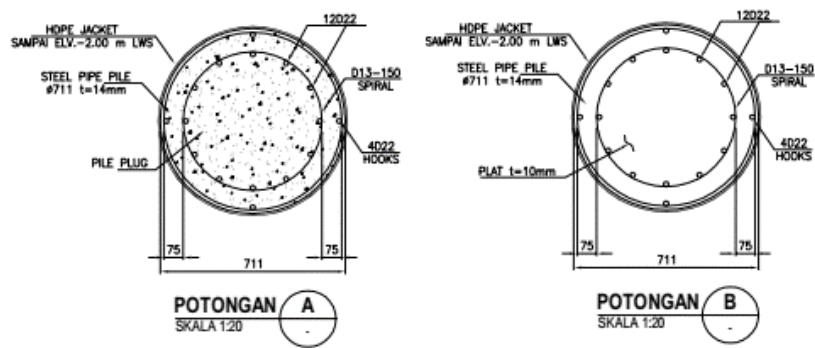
Detail potongan penulangan kepala tiang 812 jetty
